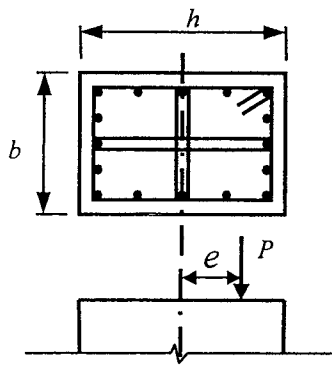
Columna rectangular con refuerzo en las cuatro caras.
